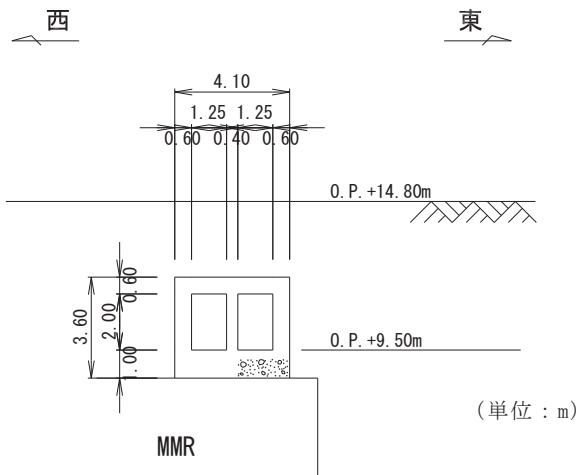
軽油タンク連絡ダクト断面図 (A-A 断面, 標準部)
